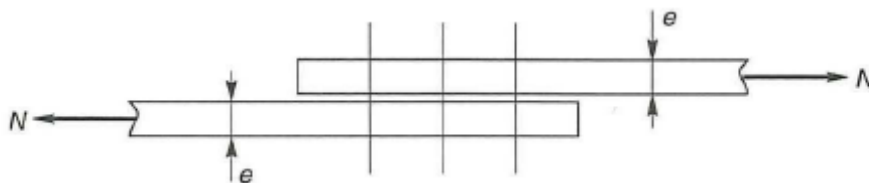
Assemblage par recouvrement simple (à exclure)
